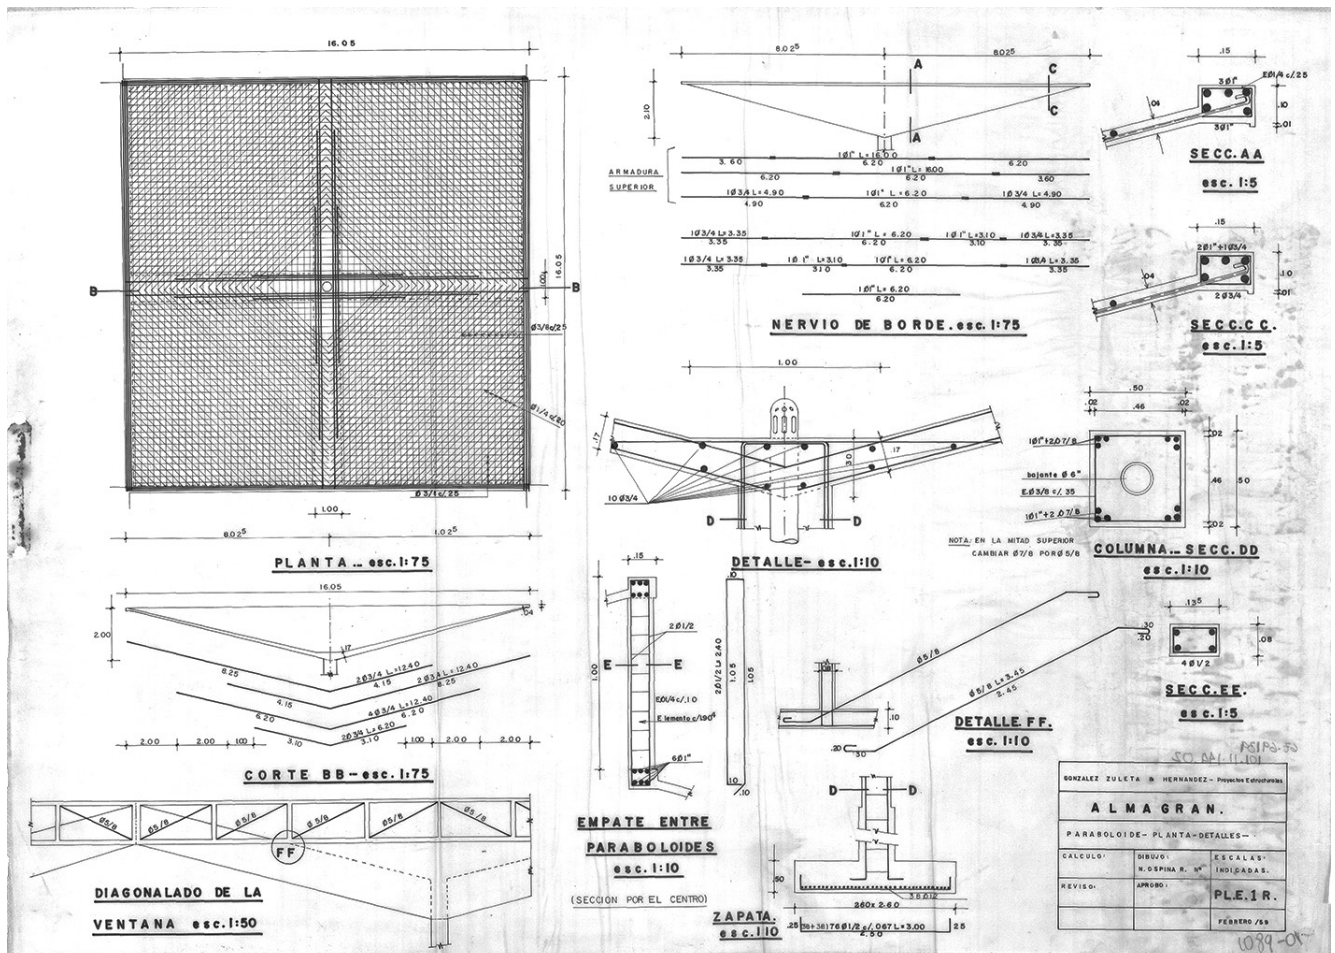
Detalle estructural de las estructuras tipo paraguas para bodegas Almagrán. Fuente: Archivo de Bogotá, Fondo Guillermo González Zuleta.
